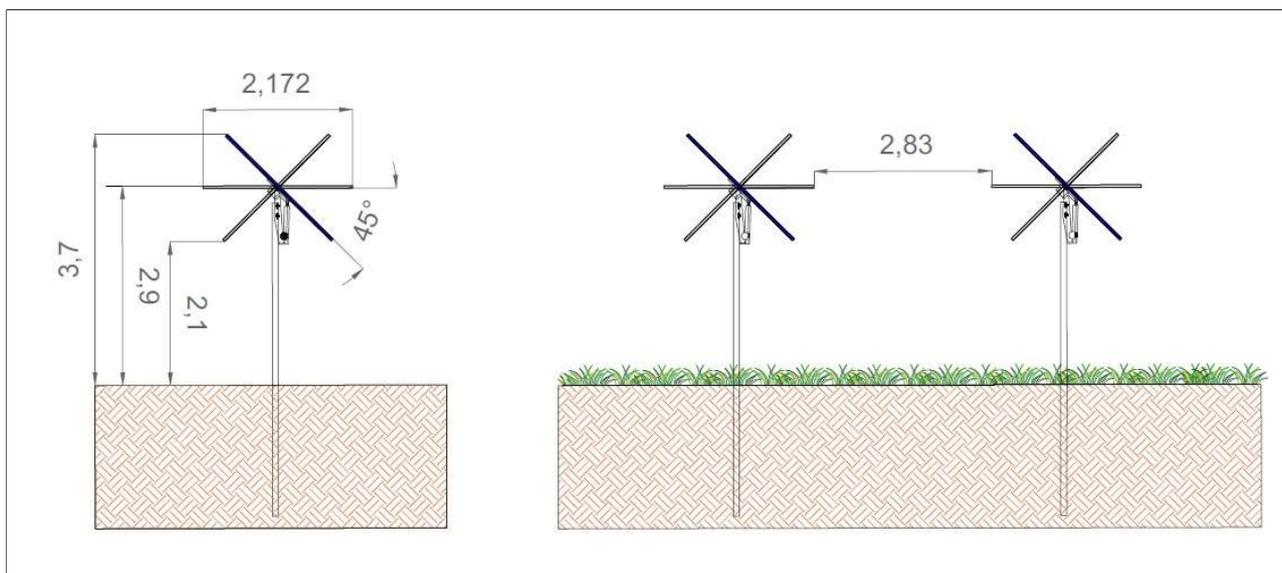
Sezione trasversale delle strutture ad inseguimento solare (tracker)
